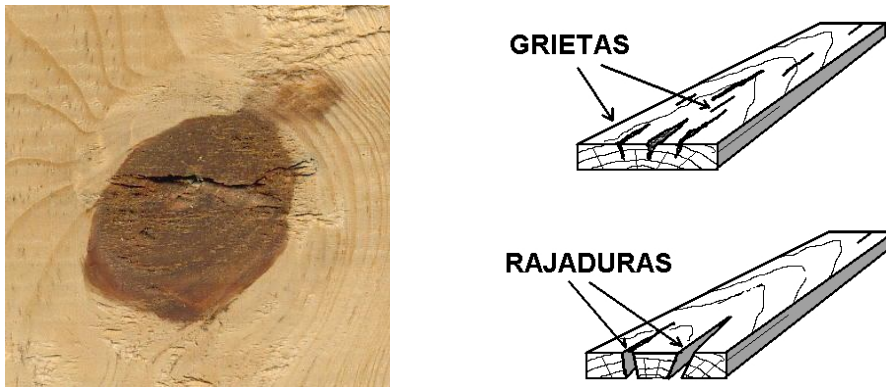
Madera con Grietas y Rajaduras.
